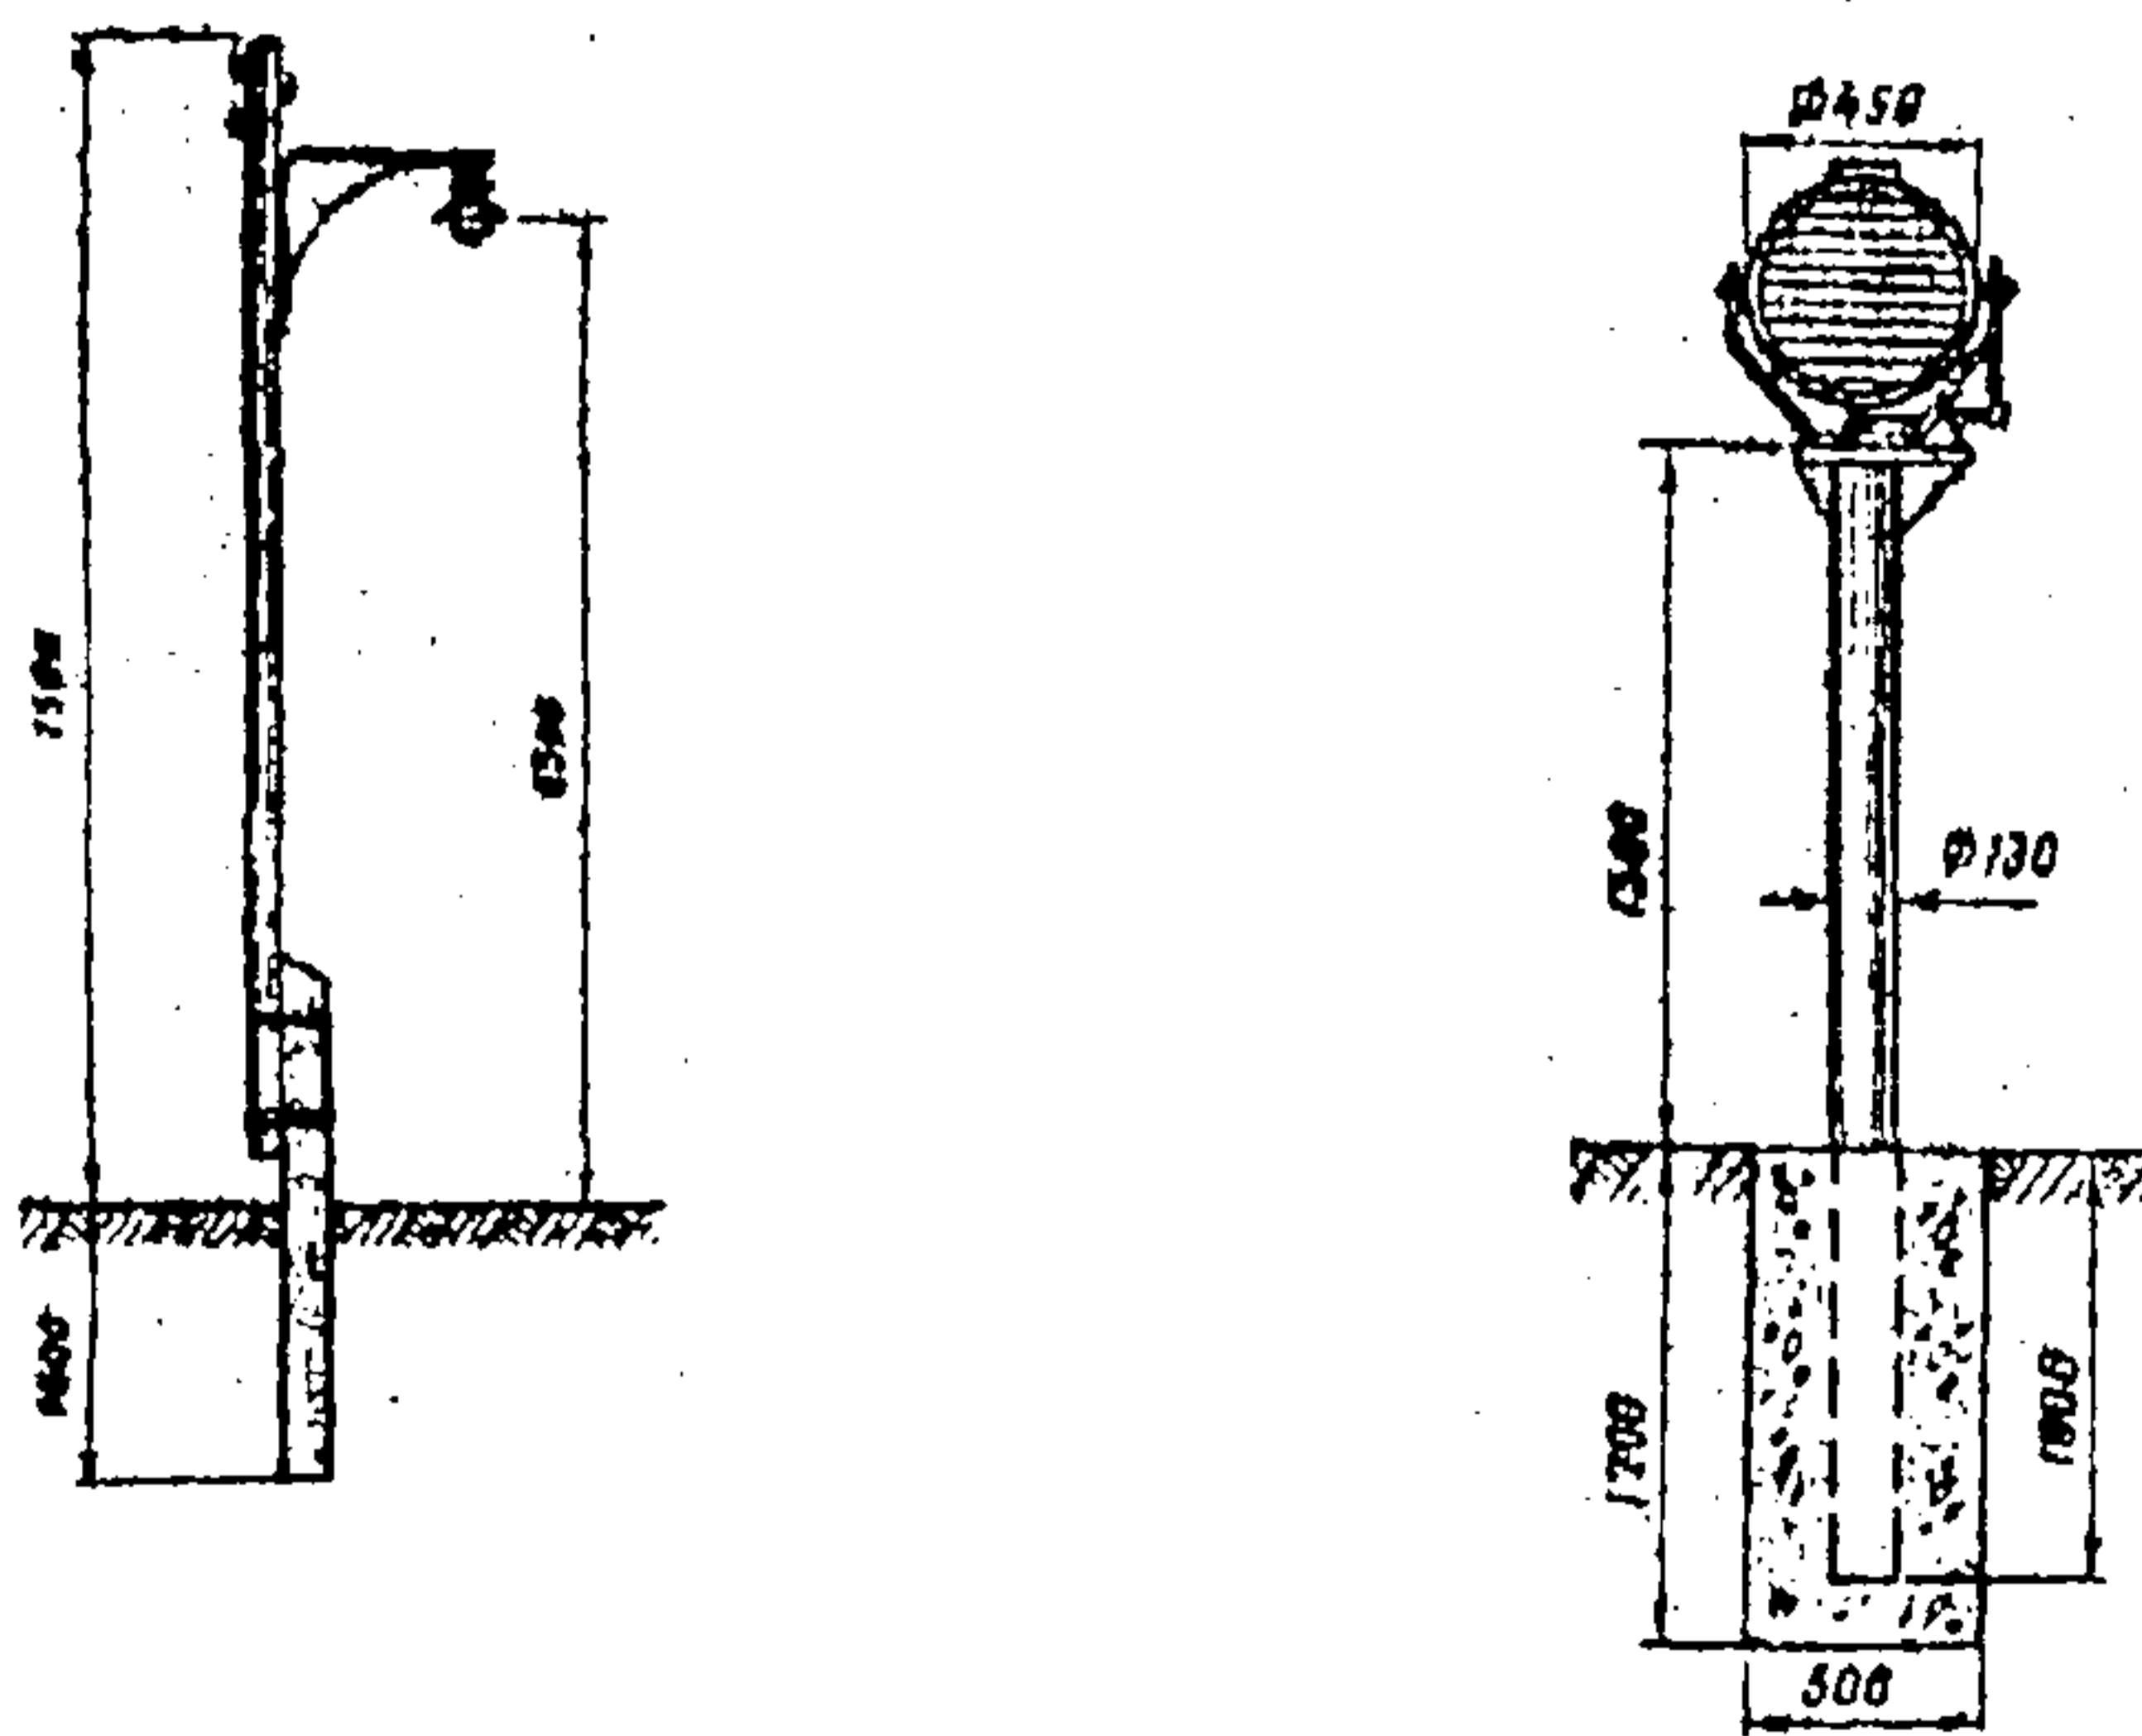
Размещение светильника охранного освещения на выносной опоре.
